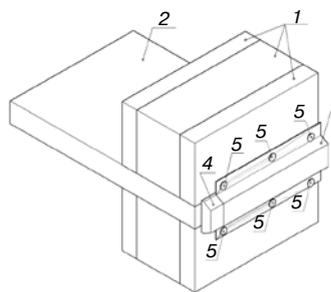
Устройство для утепления наружной стены здания: 1 – наружная стена; 2 – диск перекрытия; 3 – каркас устройства; 4 – теплоизоляционный материал; 5 – отверстия под элементы крепления
